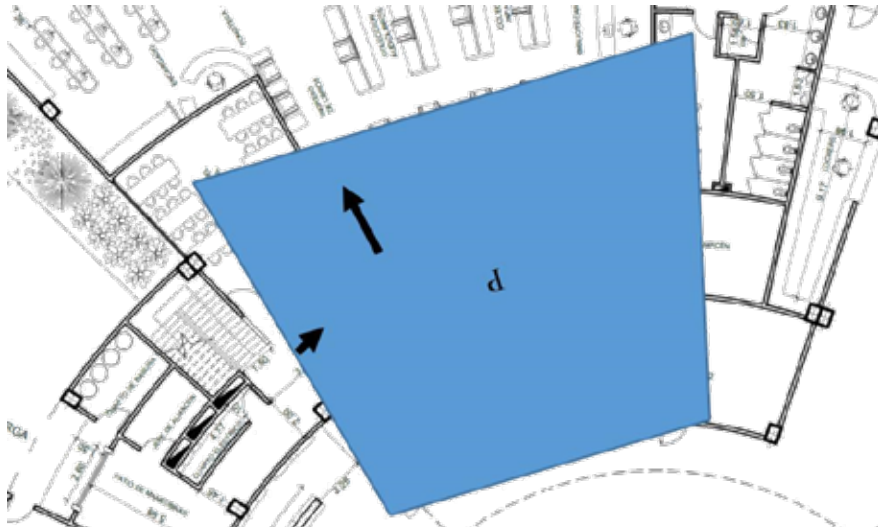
Esquema de funcionamiento en acceso posterior. Planta baja. Nivel +/-0.00 (2016)
